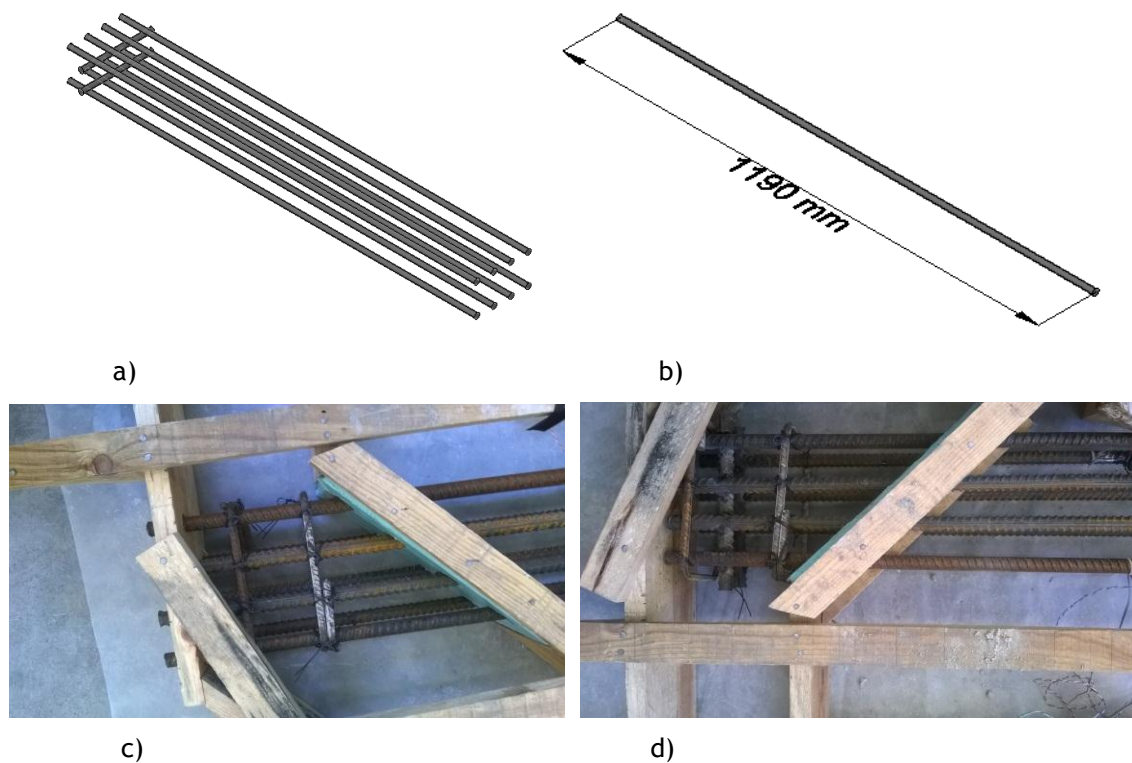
Varões com ancoragens retas e com retas com varão transversal soldado
